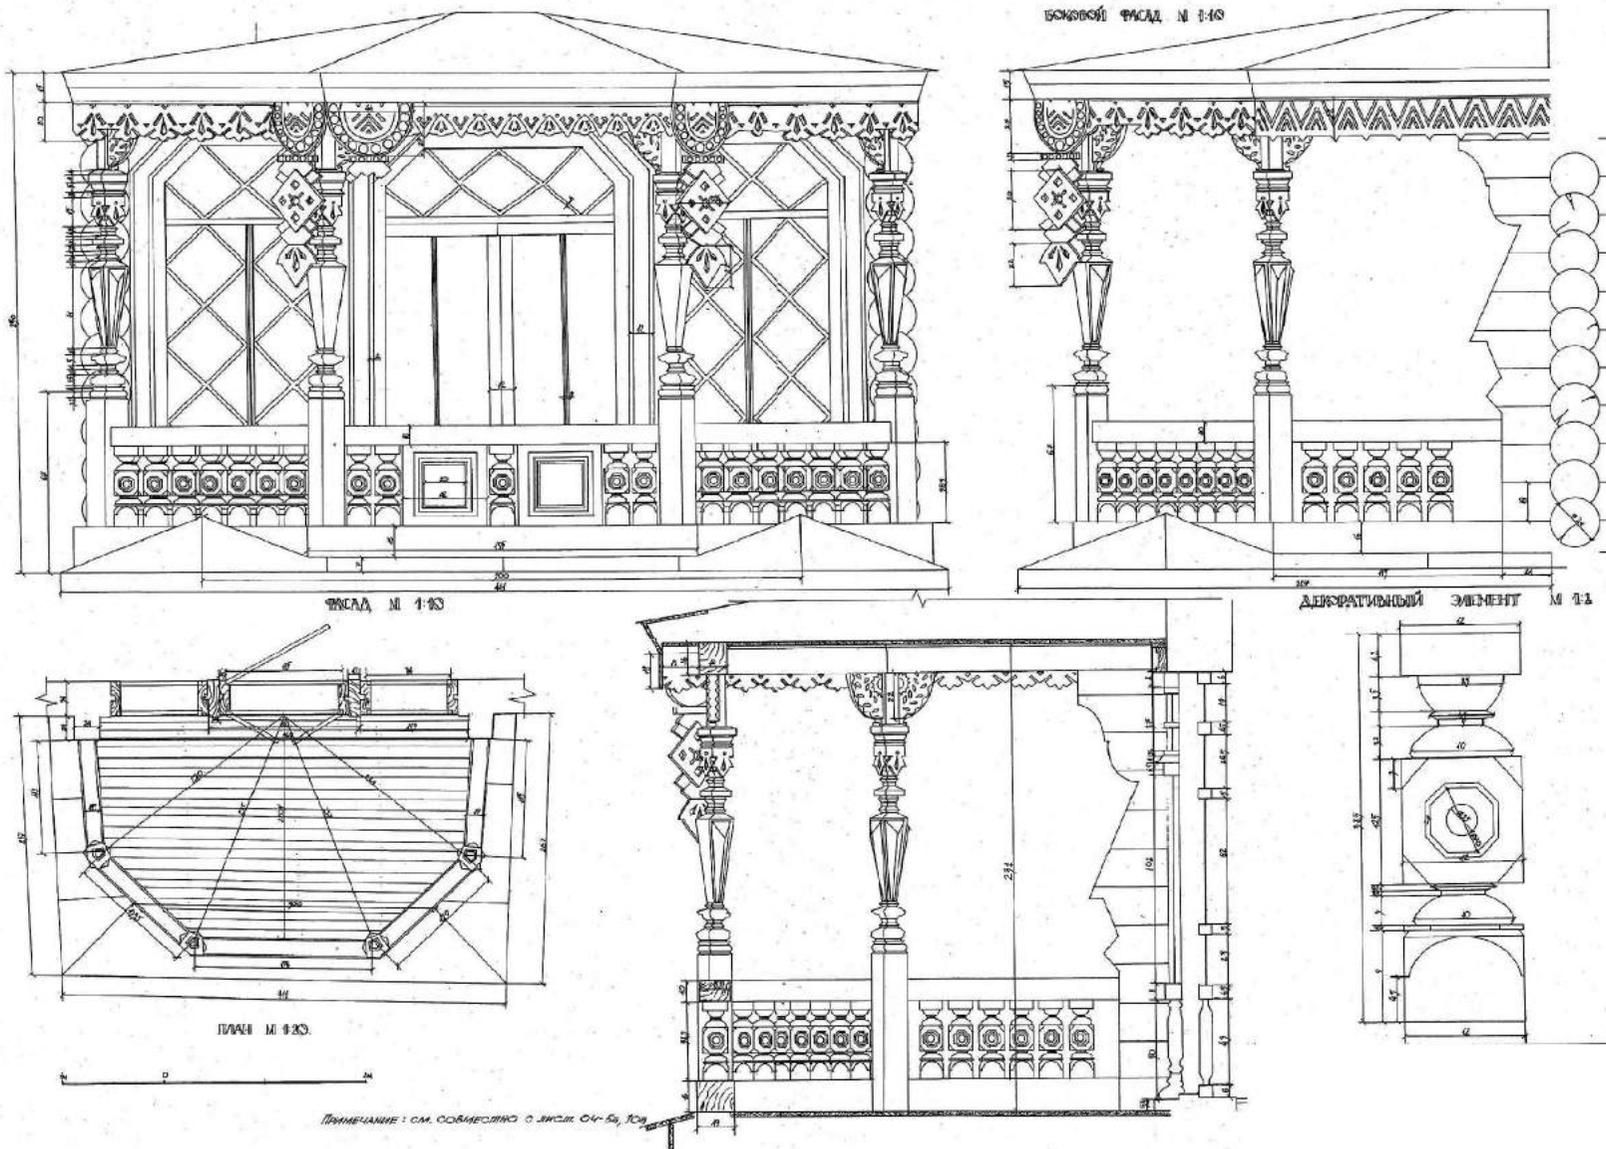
Терраса южного фасада дачи. Второй этаж. Фасады, разрез, план. Балясина. Обмерный чертеж, 2007 г.
